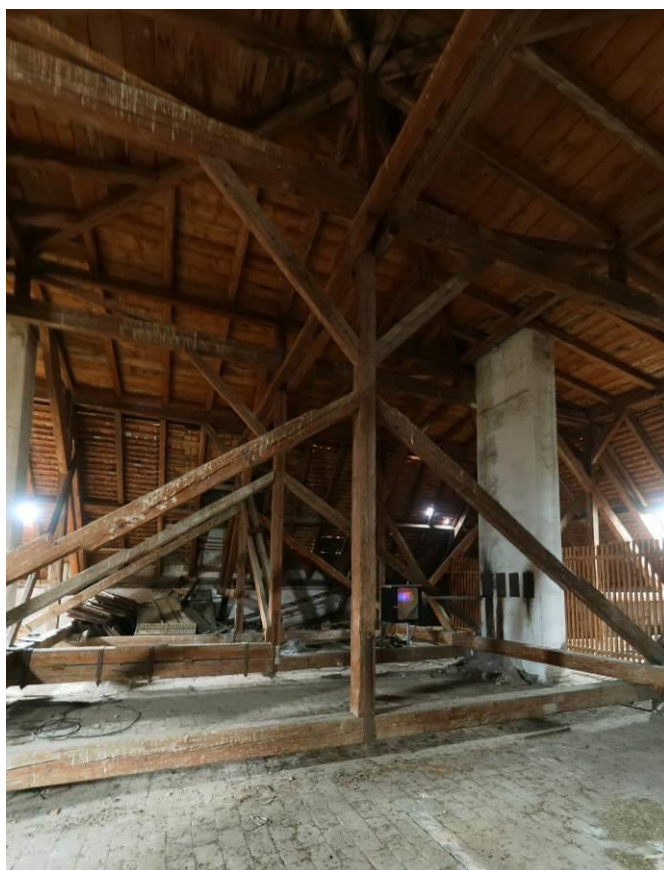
Detail napojenia konštrukcie krovu do nosných obvodových múrov
